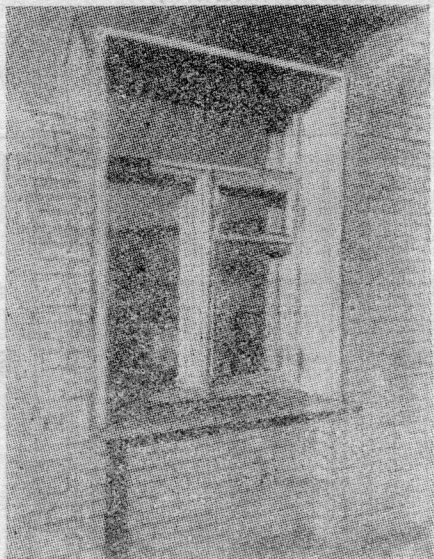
裝配式鋼筋混凝土窗砌塊全視圖
